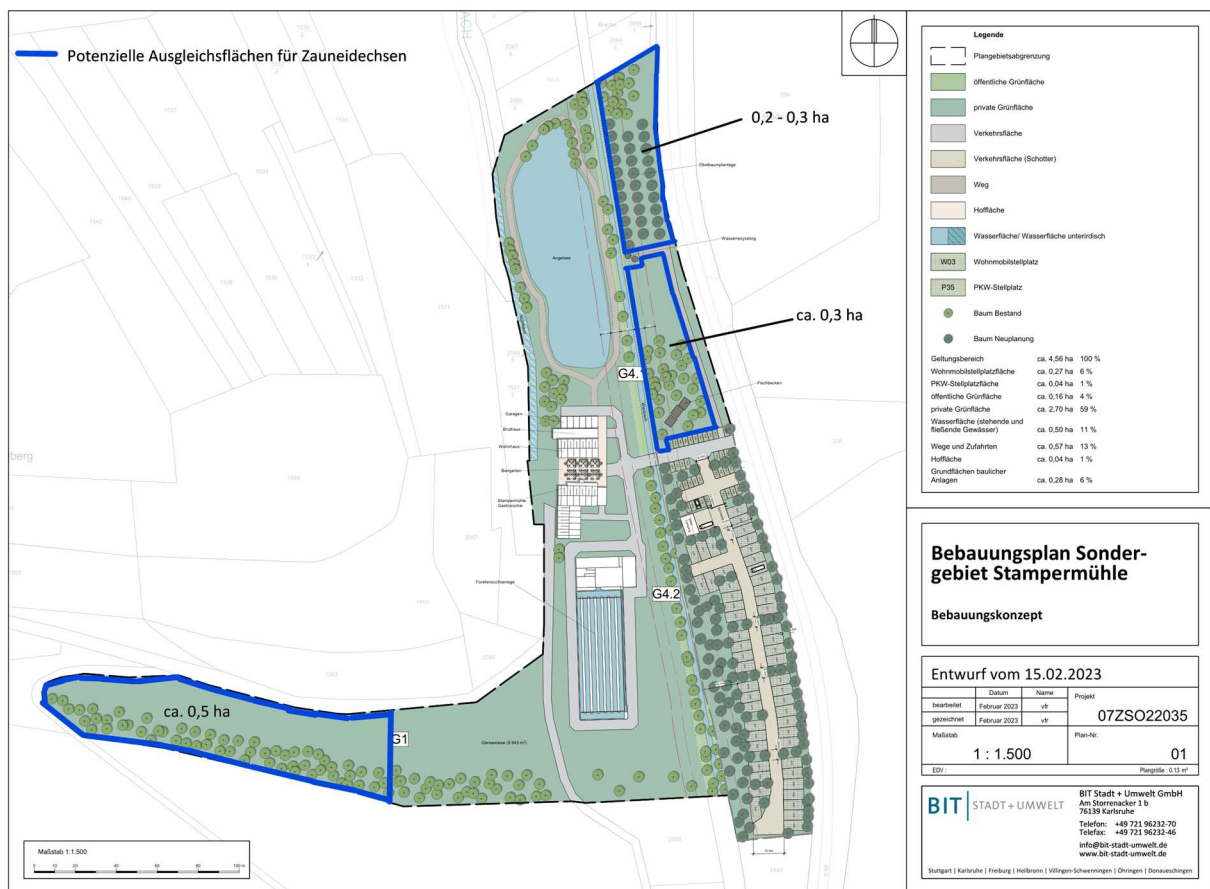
Vorschläge für potenzielle Ausgleichsflächen für Zauneidechsen. Veränderte Abbildung nach Bebauungsplan Sondergebiet Stampermühle (BIT Stadt + Umwelt GmbH).
